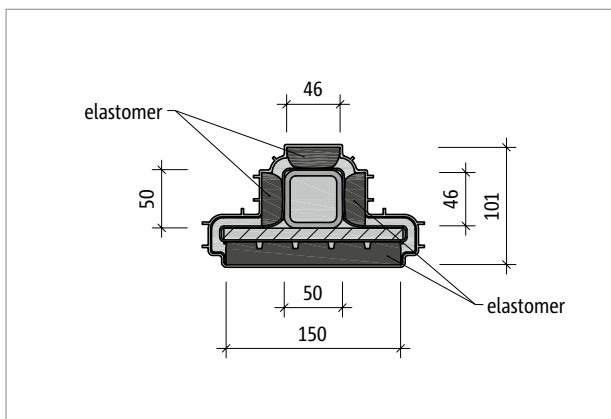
Schöck Tronsole® typ P: Půdorys prvku
